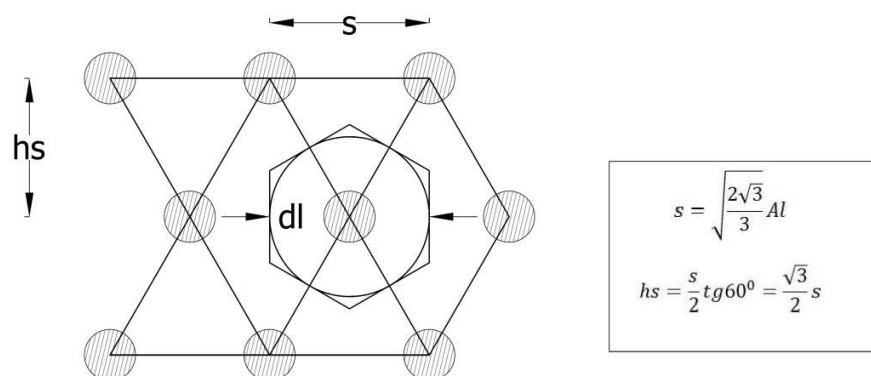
Detalle de la malla triangular en el tratamiento con columnas de grava.
